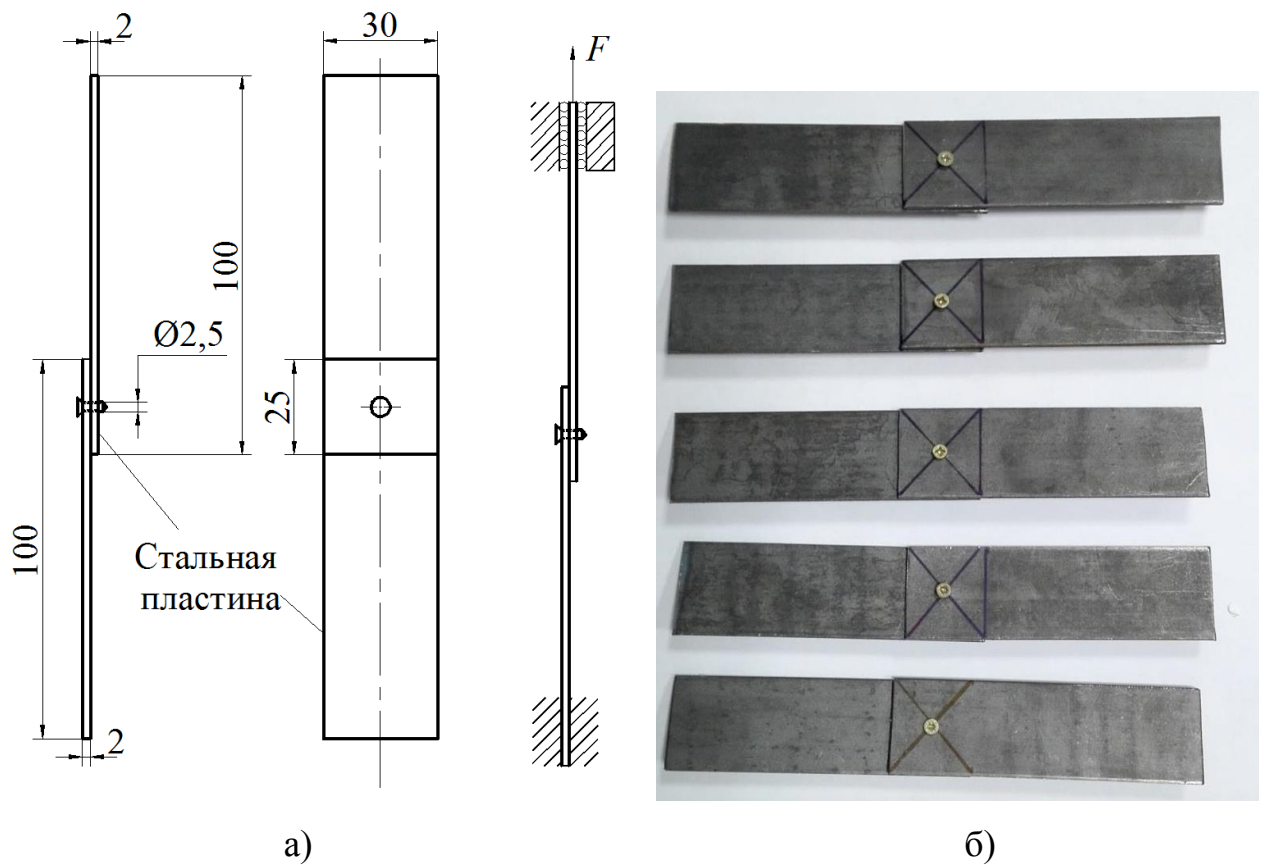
Эскиз, схема испытаний (а) и фото (б) образцов для испытаний на прочность самонарезающих винтов
